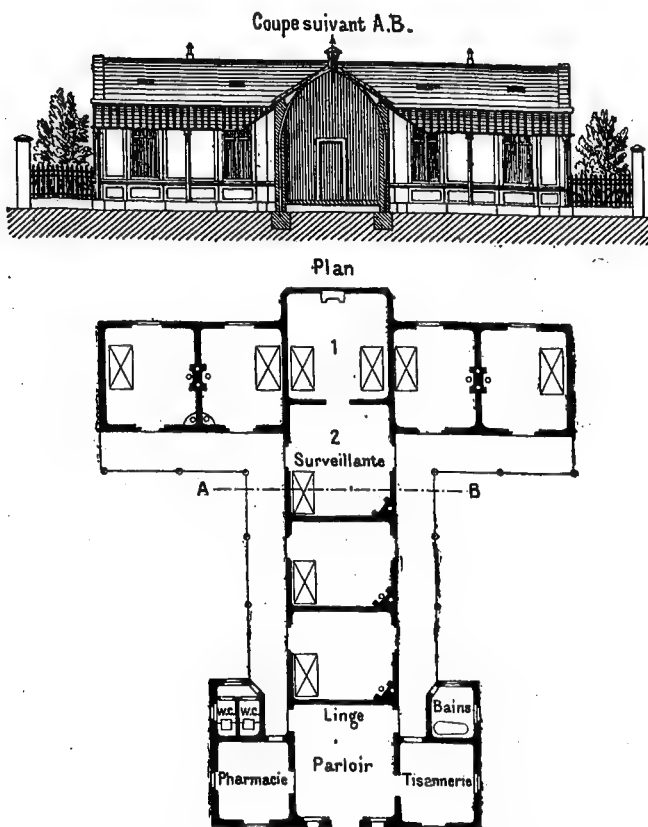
Pavillon d'isolement des femmes en couches à l'hôpital Lariboisière, construit par M. Tollet.
